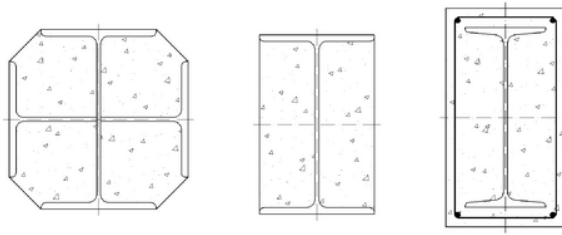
Поперечные сечения сталежелезобетонных конструкций второго типа (железобетон с жесткой арматурой)
